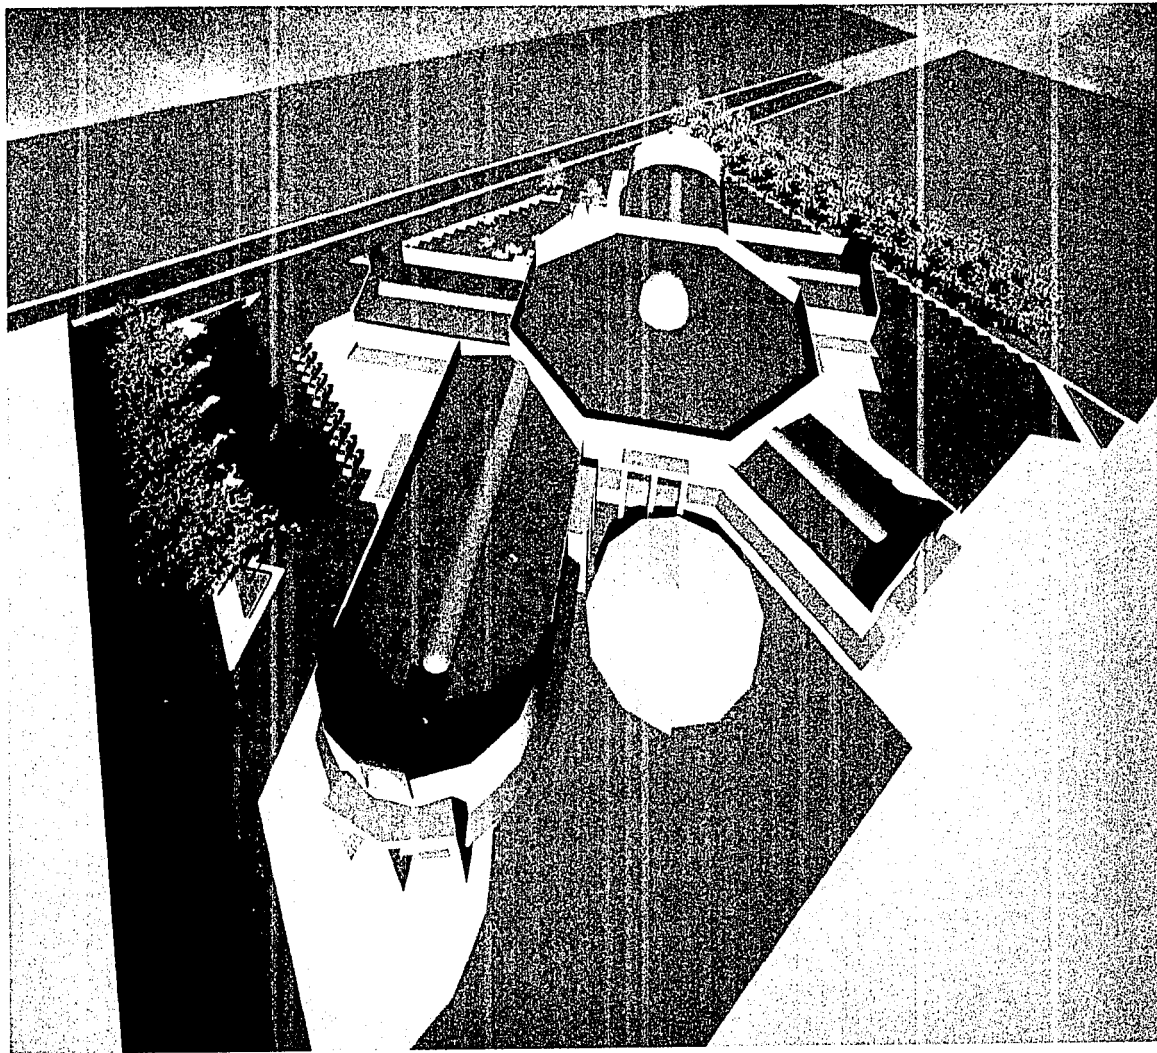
VISTA AEREA BAÑOS DE MERCADO NORTE
